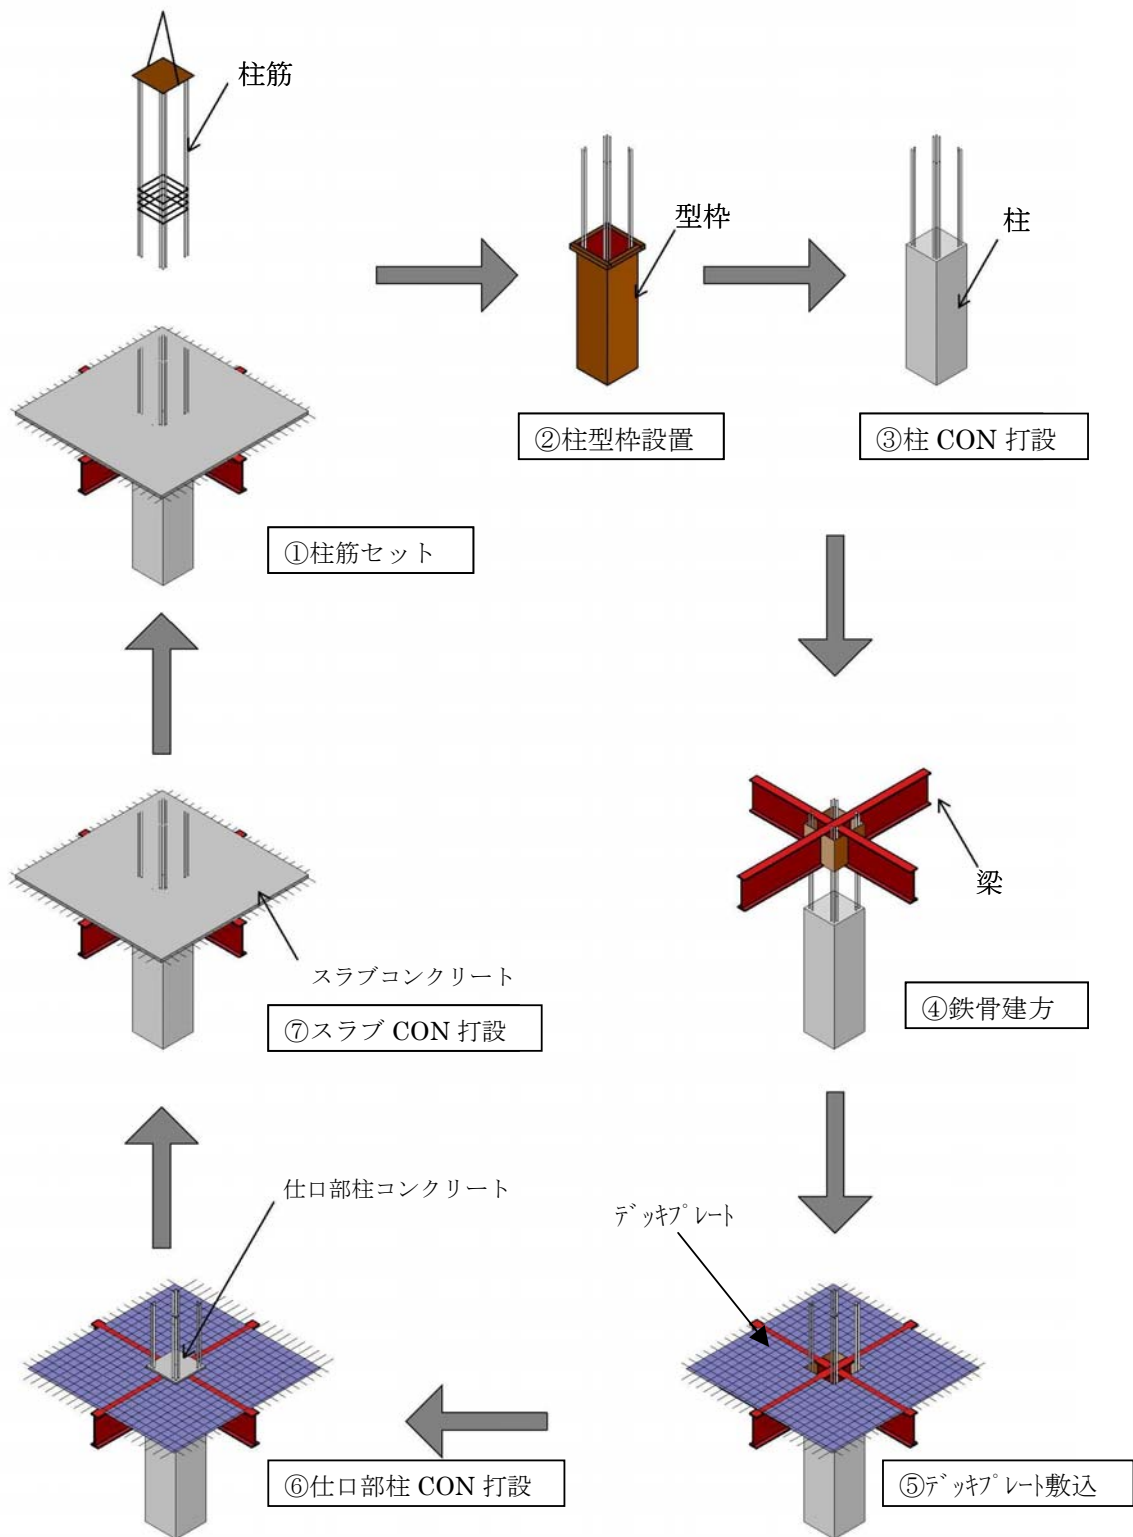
ふさぎ板形式の施工手順例 (VH分離打設)
